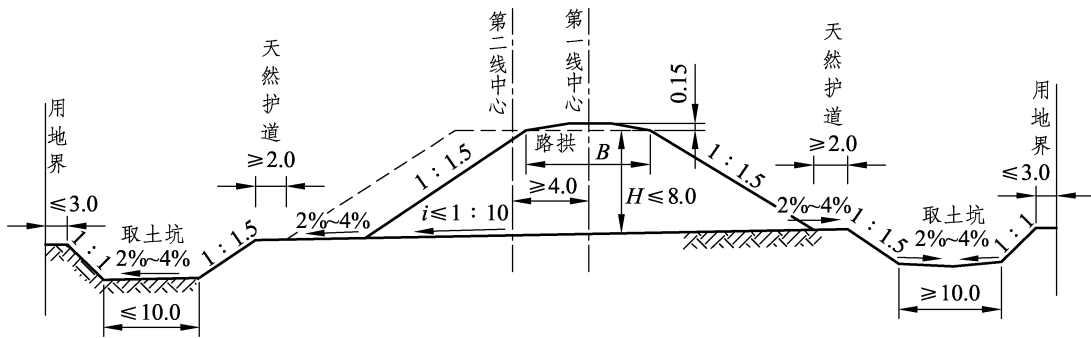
有取土坑路堤典型横断面图 (单位: m)
